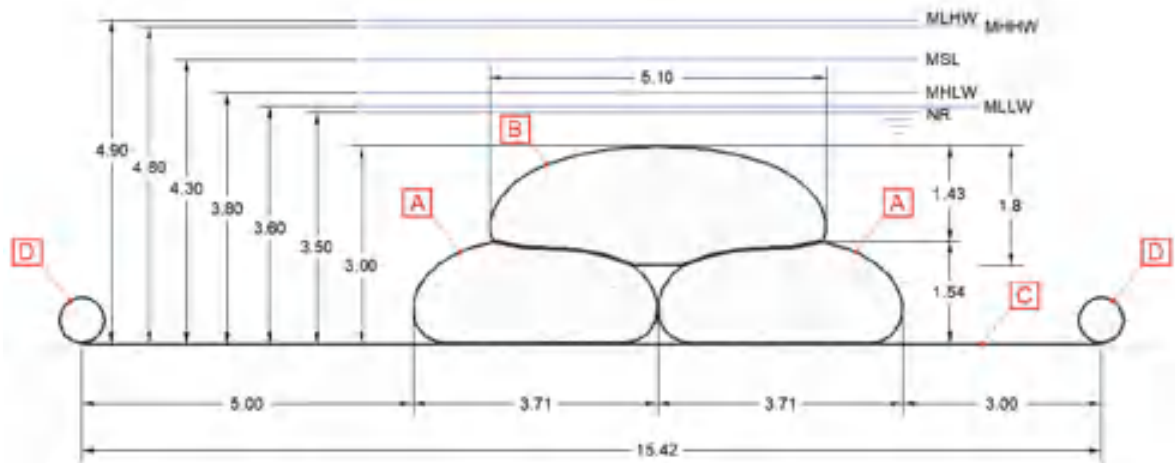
Seção transversal completa do segmento longitudinal da obra-piloto. Fonte: Garcia e Gireli, 2019.
